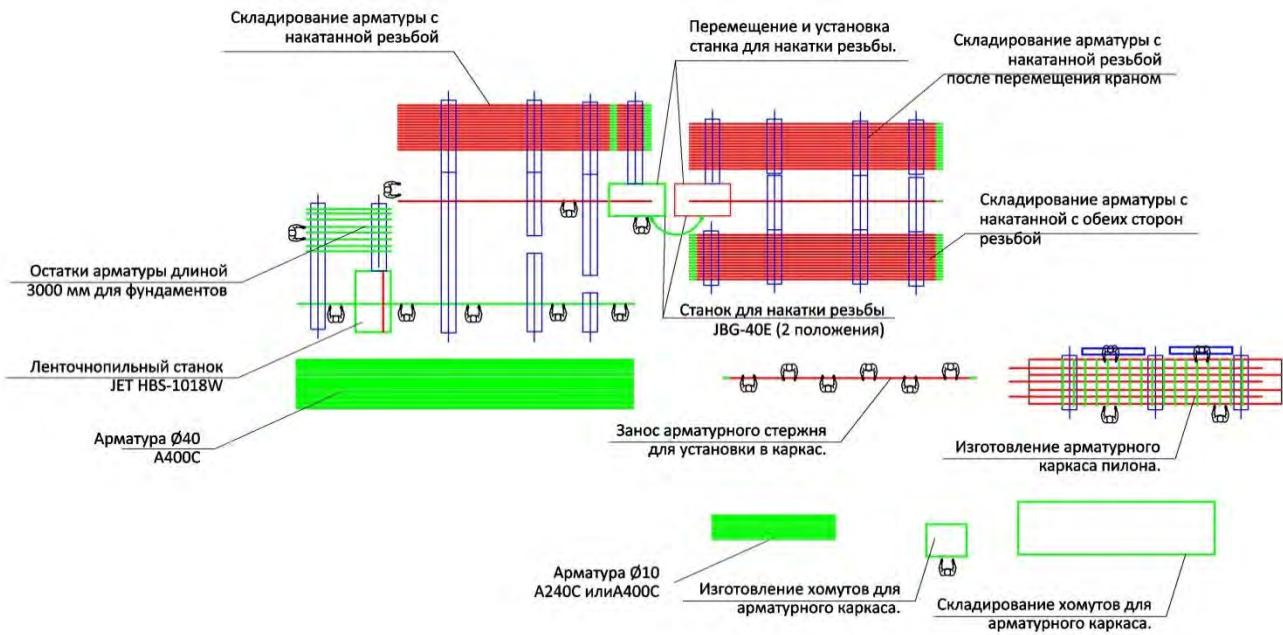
Общая схема выполнения работ по изготовлению арматурных каркасов при резьбовом соединении арматуры
